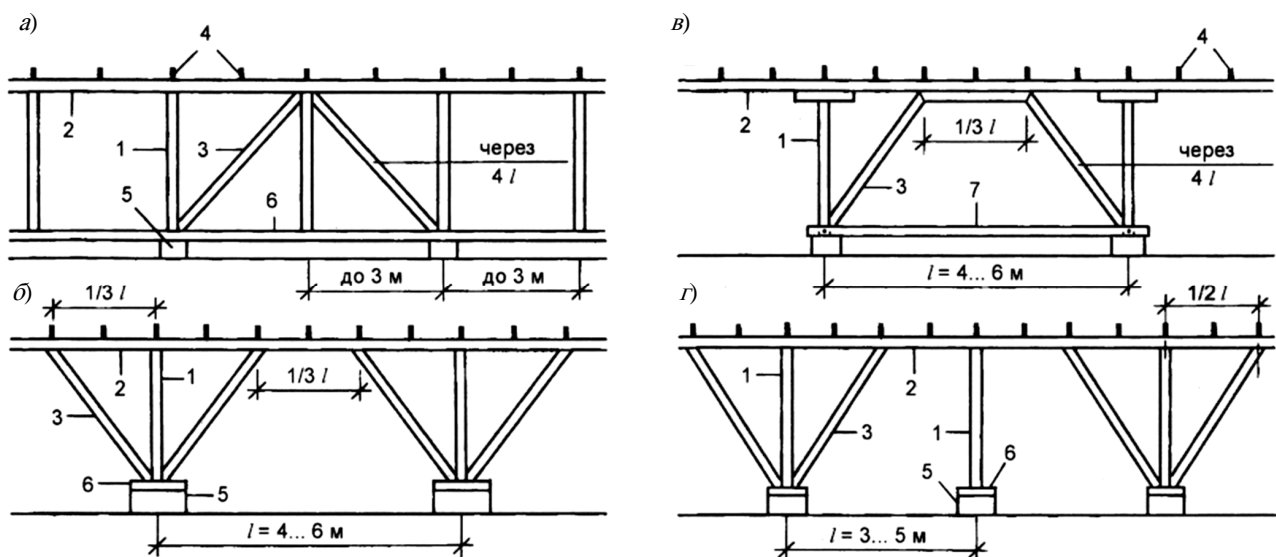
Схемы деревянных продольных стропильных рам и их элементы:
